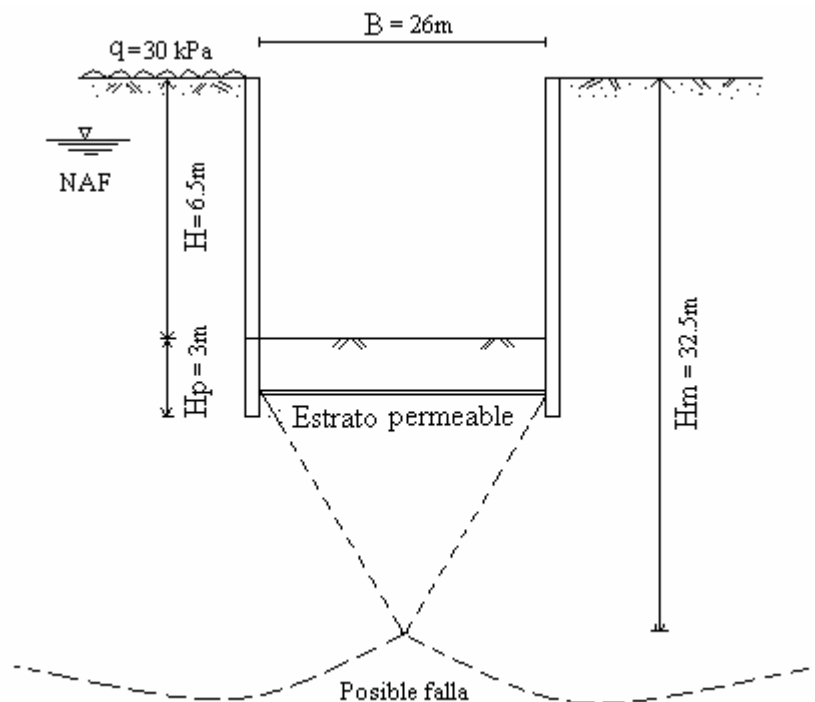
Geometría de la excavación donde puede ocurrir falla de fondo
